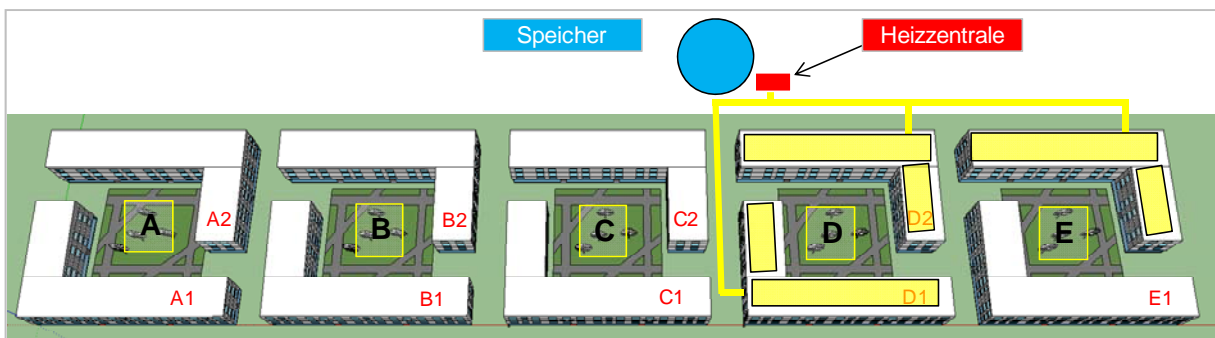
Auszug Lageplan Quartier Neubau mit Solarnetz und Lage des Speichers inkl. Heizzentrale
